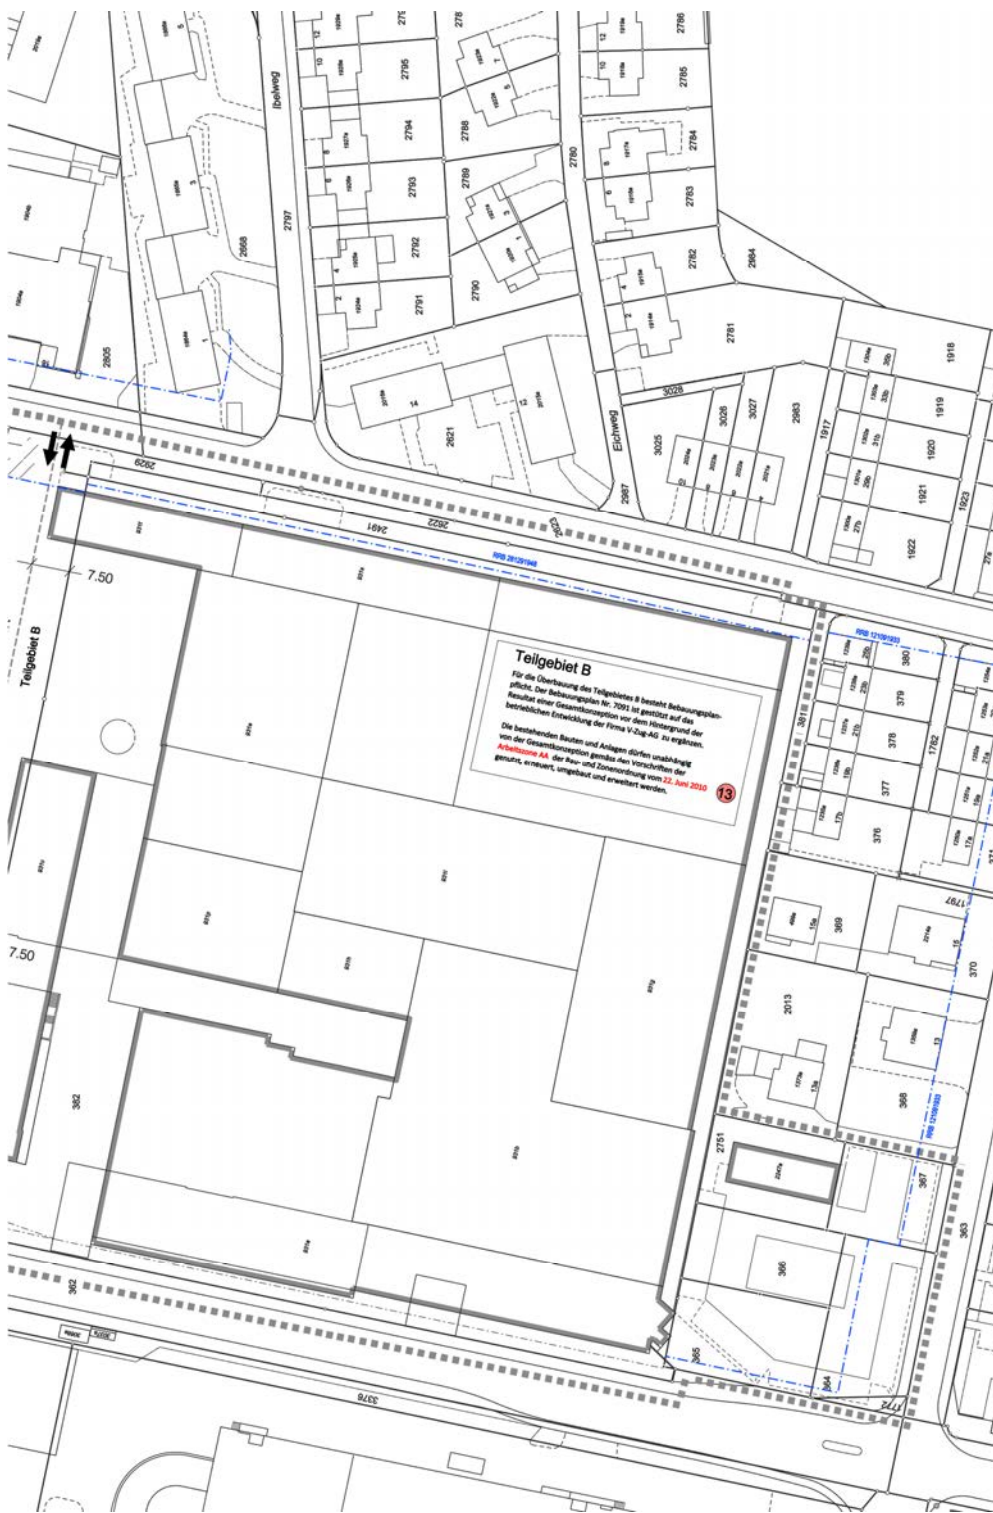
Auszug aus dem Bebauungsplan V-ZUG, Plan Nr. 7091, von der kantonalen Baudirektion genehmigt am 17.01.2012
